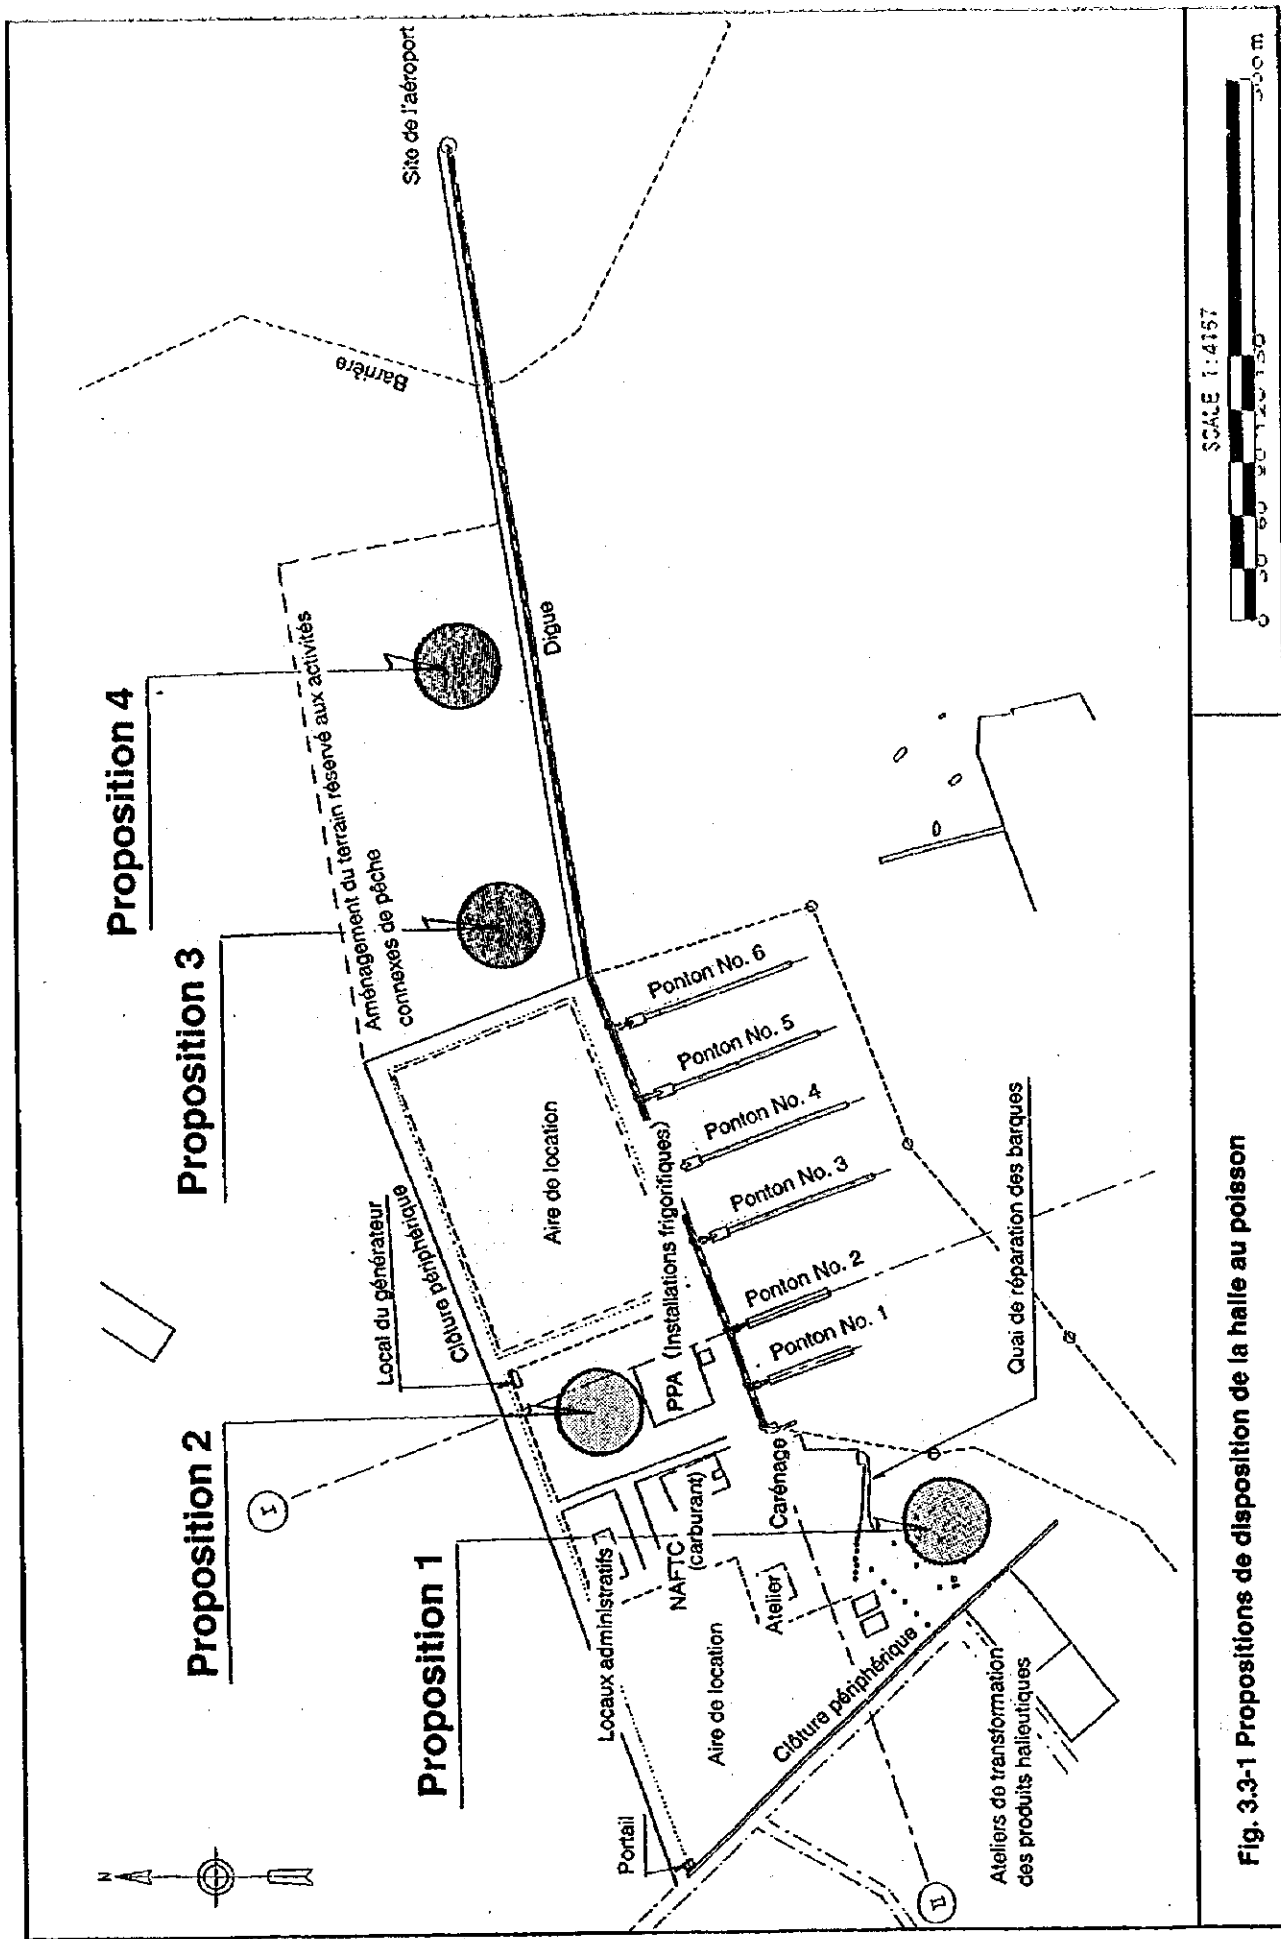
Propositions de disposition de la halle au poisson
